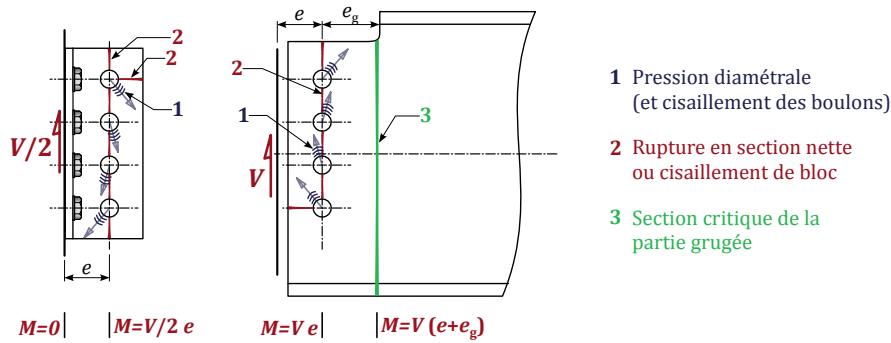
Fonctionnement de l'assemblage coté poutre portée
